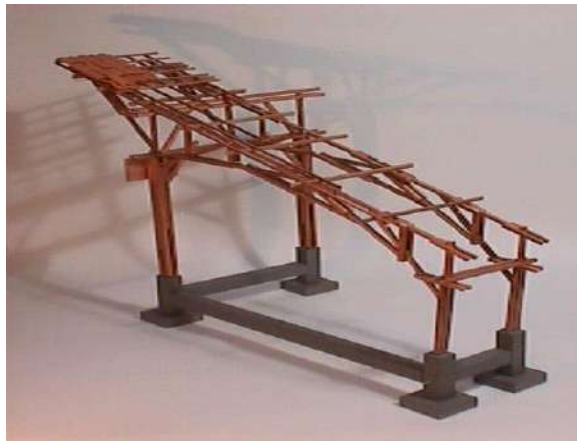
sistema constructivo madera procesada con uniones empernadas posmoderno
